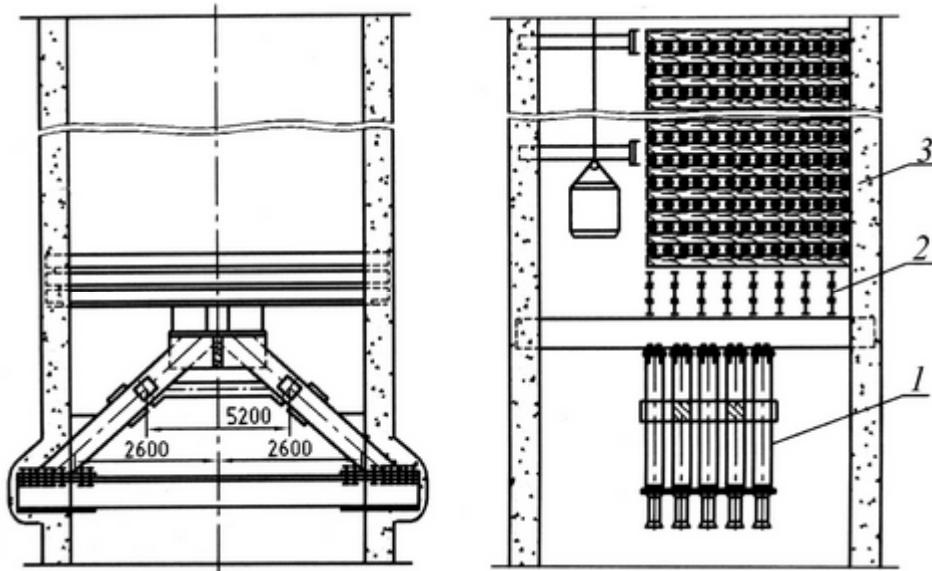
Конструкция полка с фермами треугольной формы:
